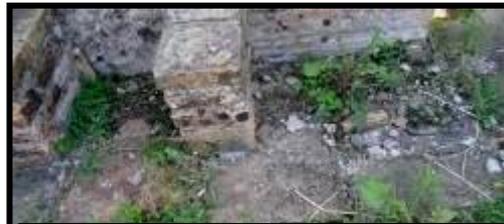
Particolare delle tegole di rivestimento tra il quinto e sesto pilastro della parete est.
